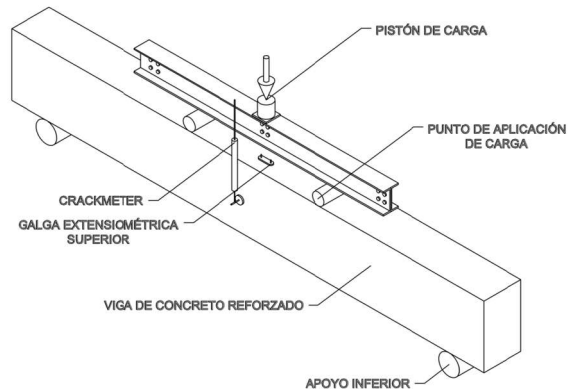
Diagrama de carga e instrumentación de las vigas reforzadas
